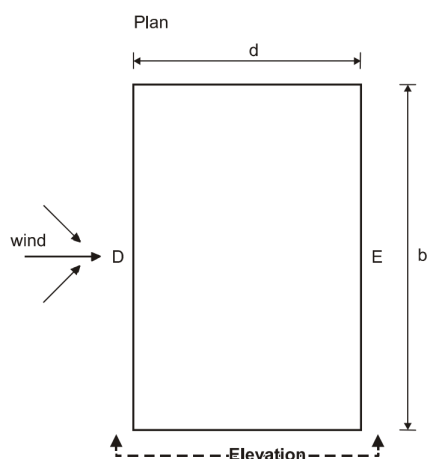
Planta de um edifício rectangular e paredes verticais
